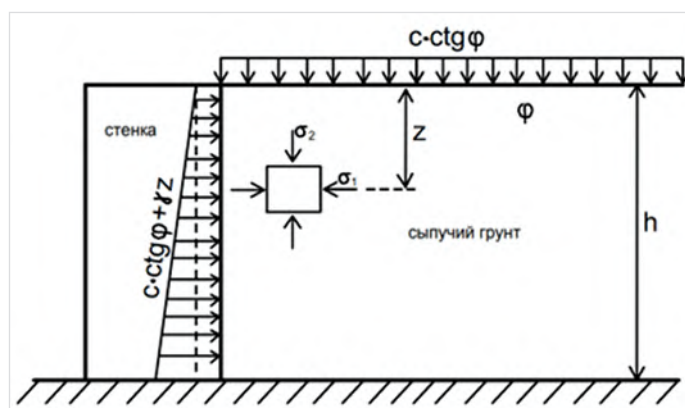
Эквивалентная расчетная схема стенки с грунтом
